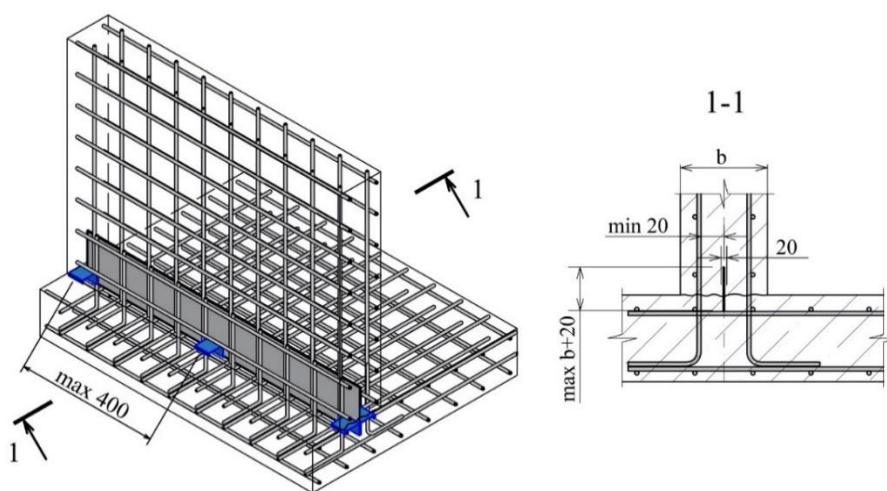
Схема основных допусков по монтажу листовой металлической гидрошпонки в технологическом шве бетонирования (стык вертикальной и горизонтальной конструкции)
